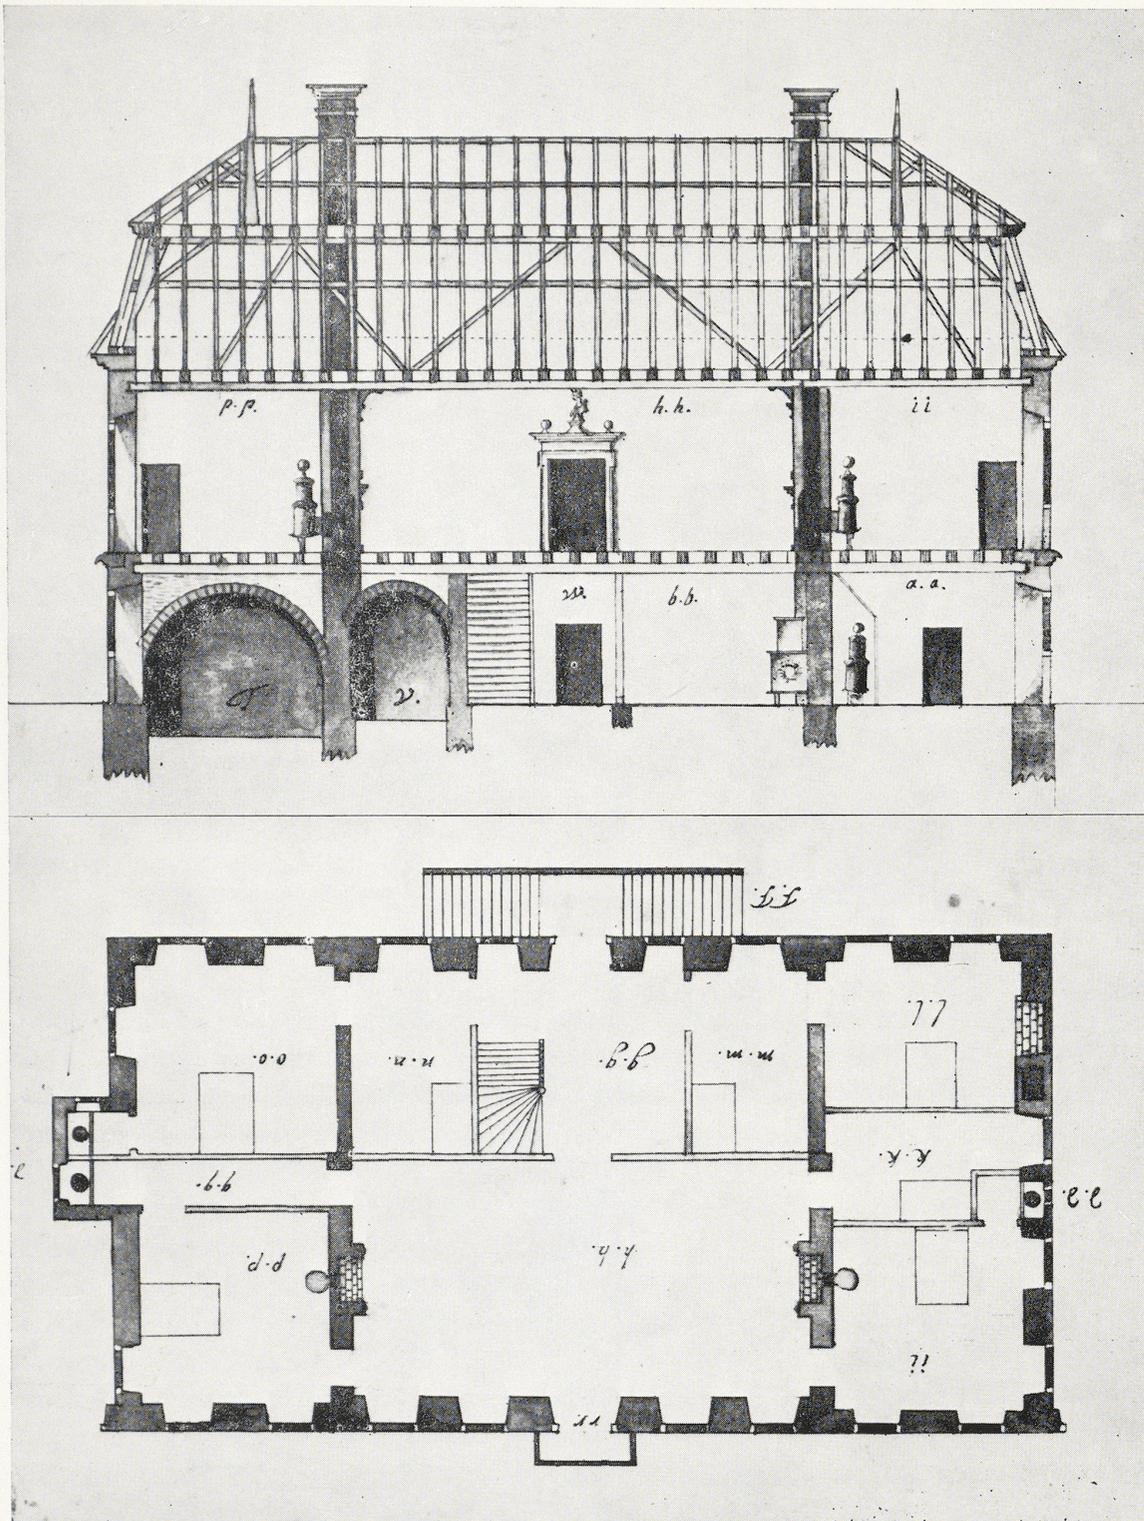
Bekond, erstes Projekt von P. H. Ravensteyn 1709, Längsschnitt und Hauptgeschoßgrundriß (P1, P2)
